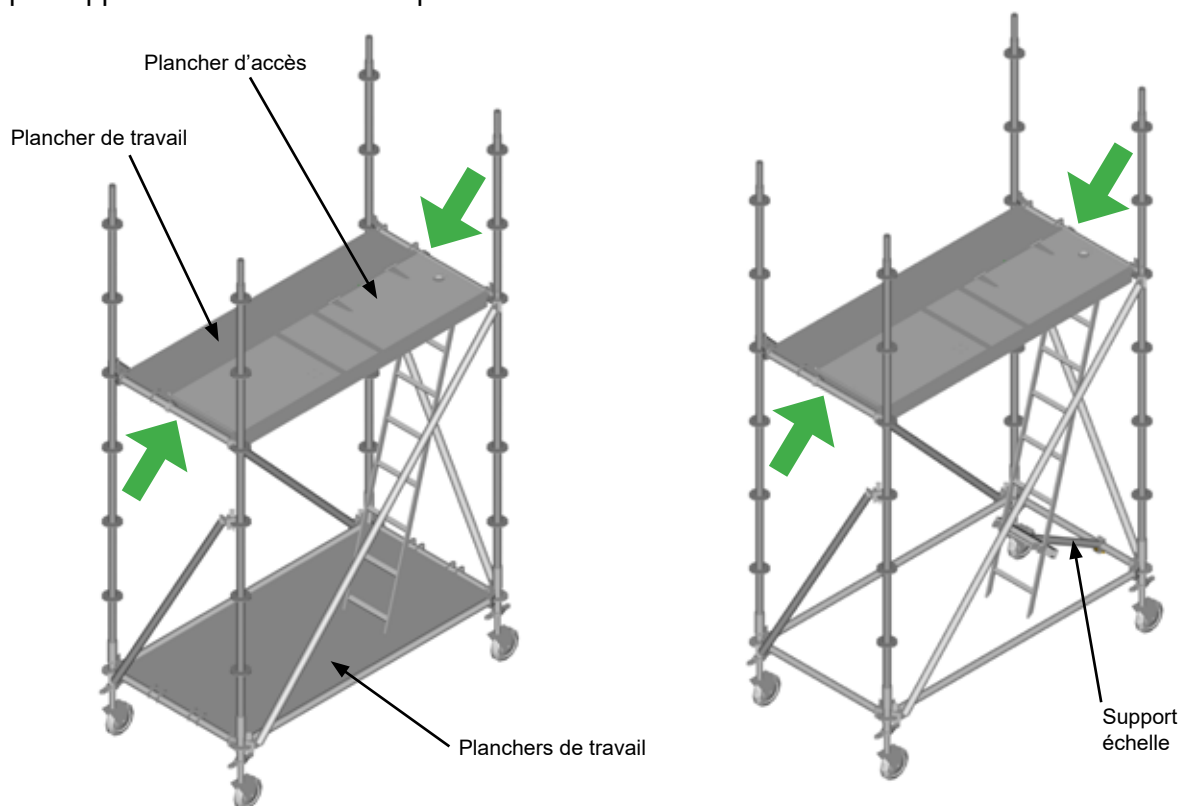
Planchers sur les lisses situées à une hauteur de 2 m par rapport aux éléments de départ. Palier d'échelle sur les planchers.
